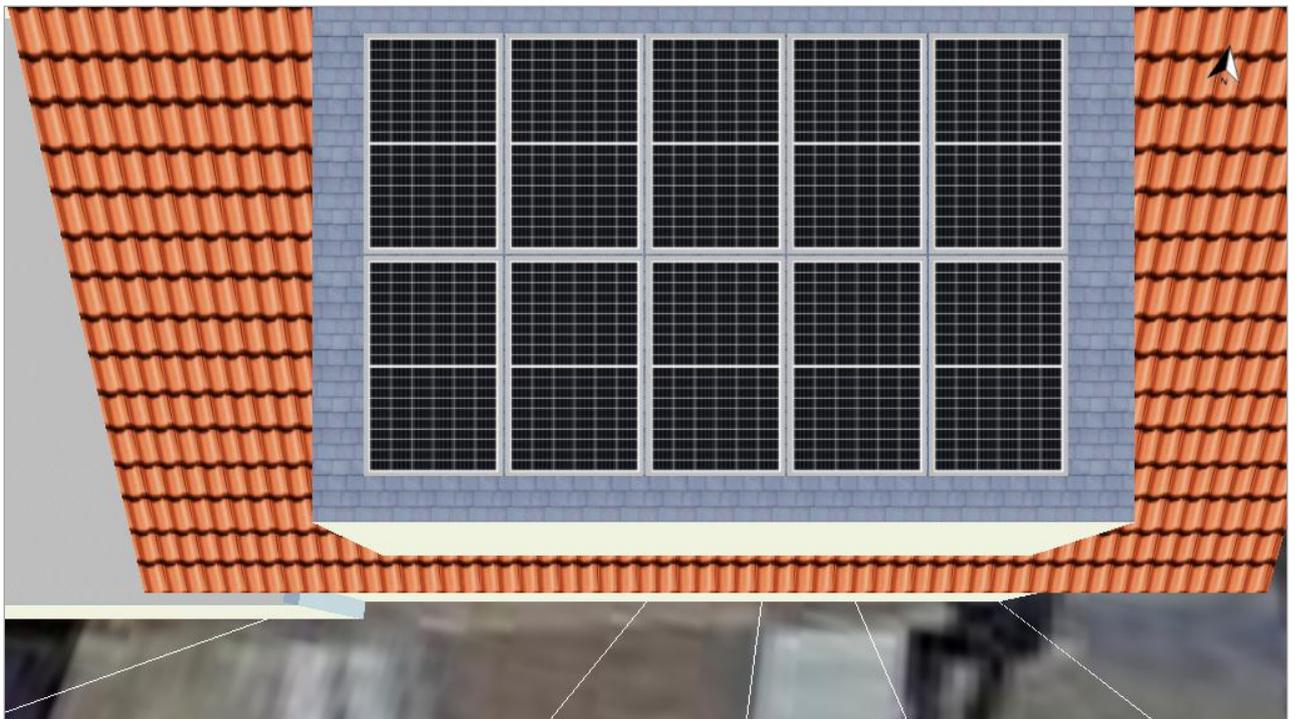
Modulfläche - Dachgaube 01-Dachfläche Süd
